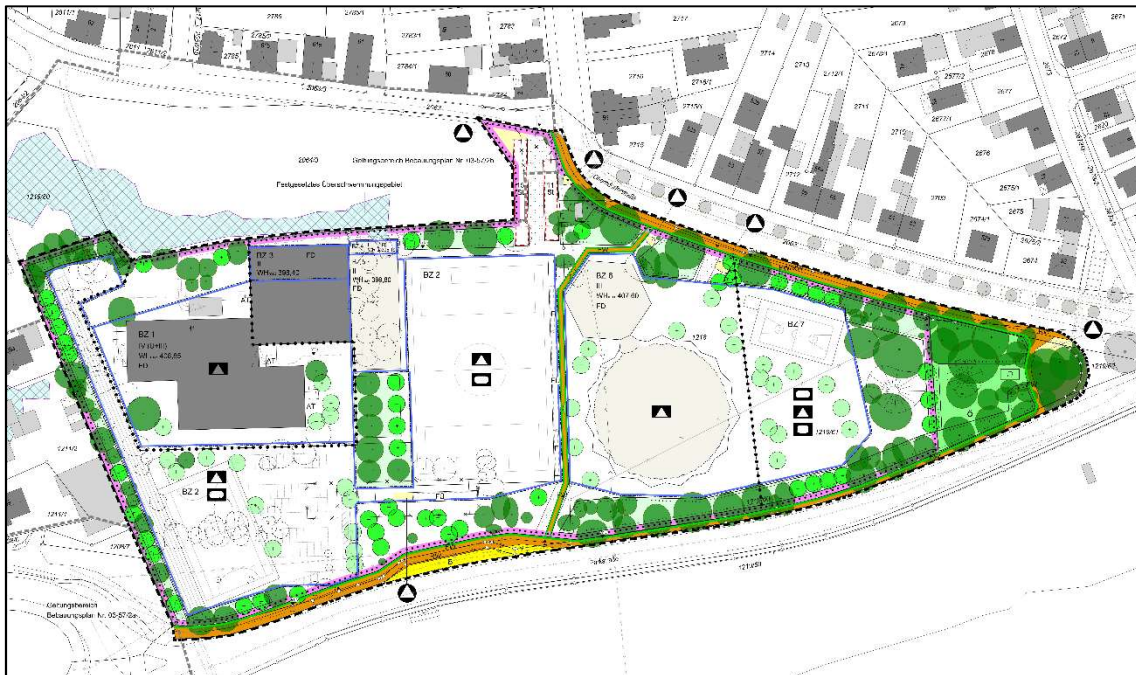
Planzeichnung zum Bebauungsplan Nr. 03-57-2c "Zwischen der Oberndorfer Straße und Parkstraße" der Stadt Landshut /13/
